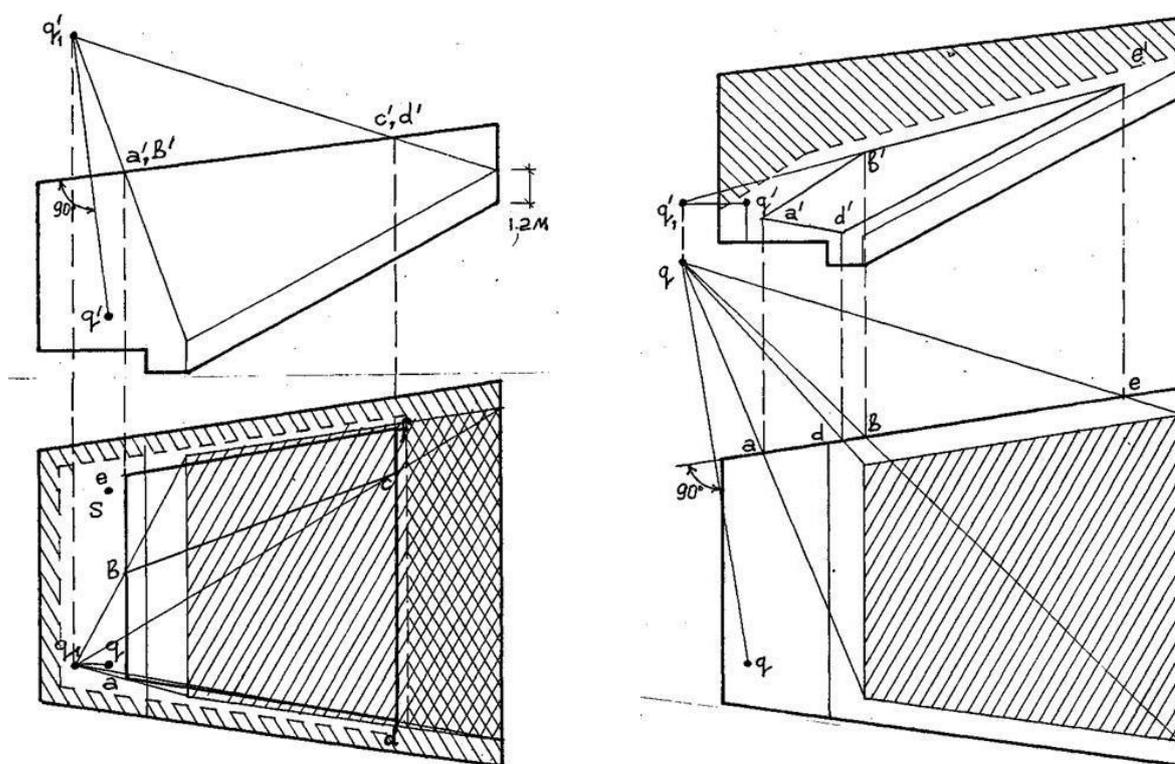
Рекомендуемые зоны размещения звукопоглотителей в зальных помещениях заштрихованы: а - на стенах, б - потолке
